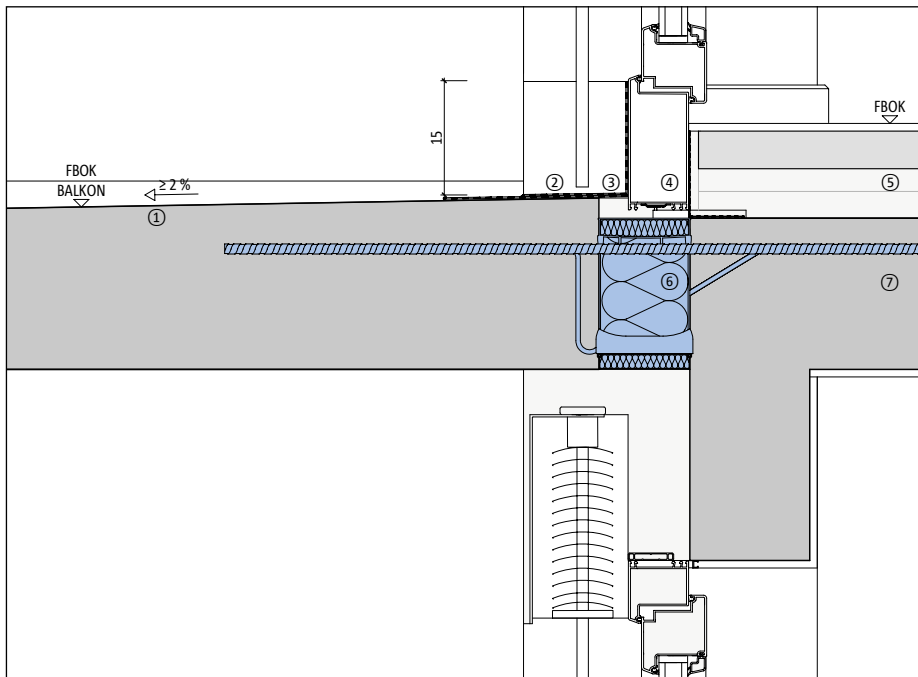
| M. 1:10 Fertigteilbalkon mit Aufbau
